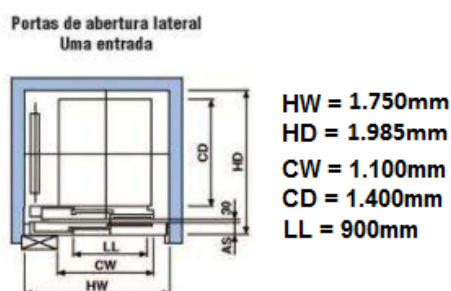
Croqui em corte da caixa de corrida do elevador sugerindo posicionamento de componentes e estabelecendo requisitos dimensionais em sua seção transversal
